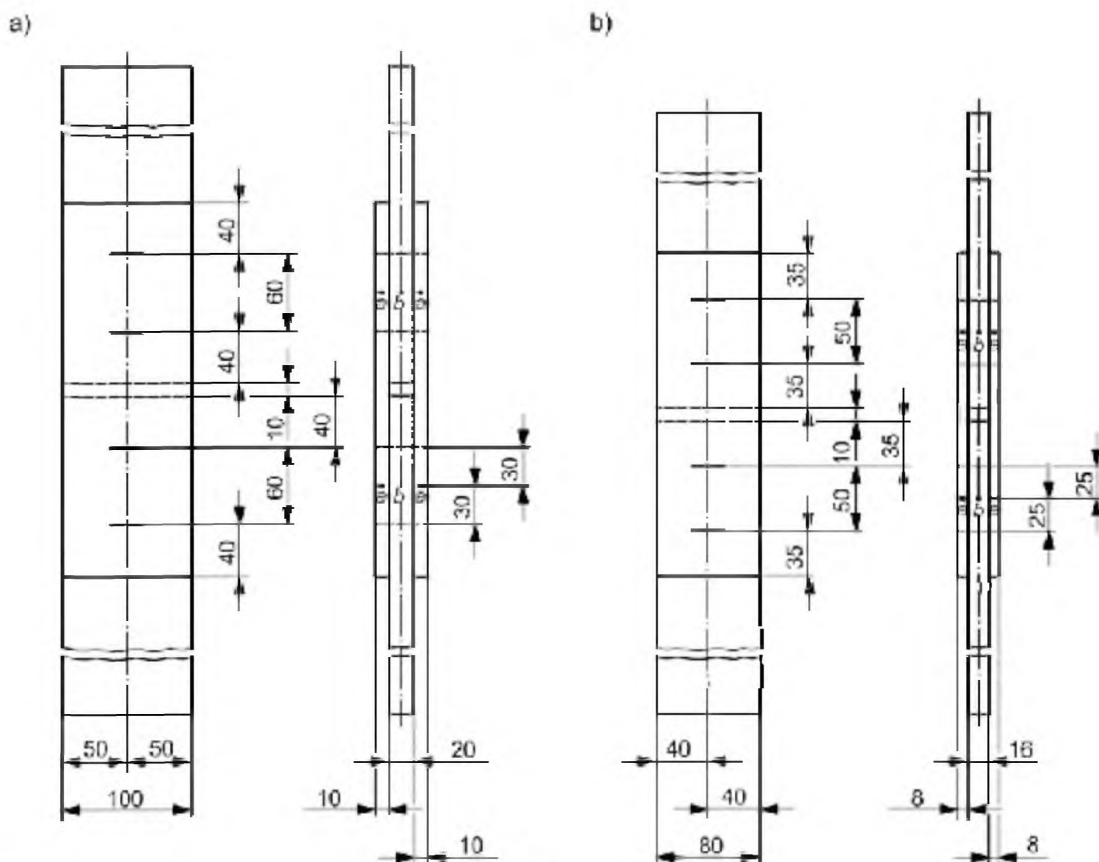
Стандартные образцы для испытаний по определению коэффициента трения:
